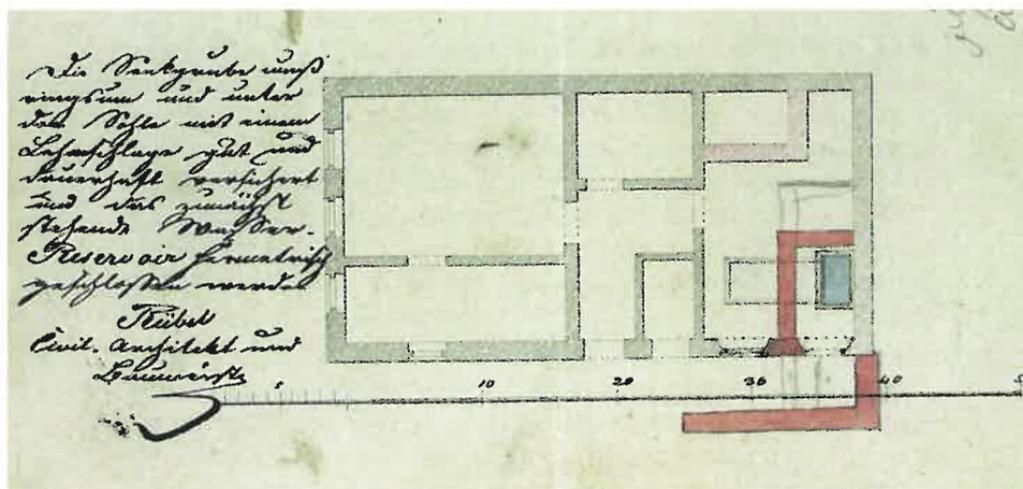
Plan des Hauses Webergasse 225; 1843
